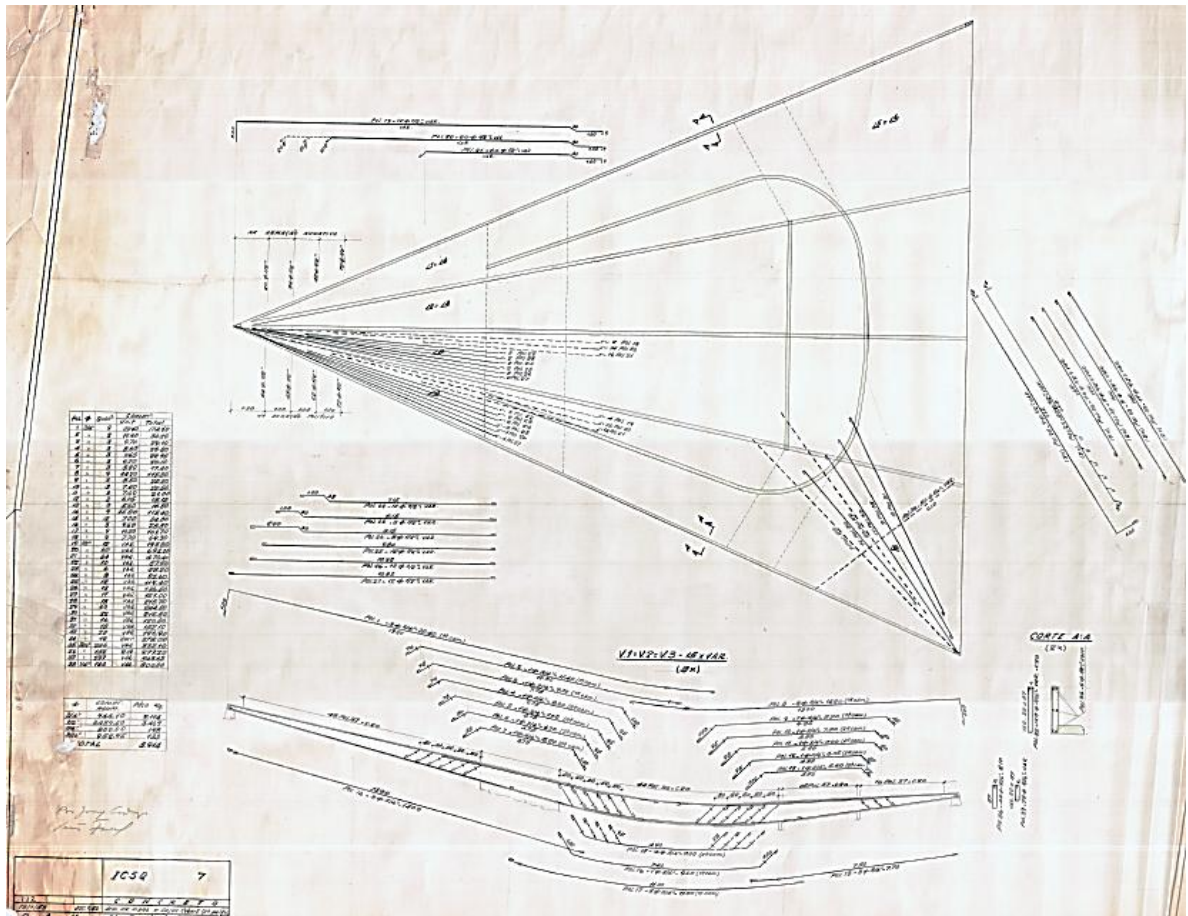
| Armação vigas e lajes - 2ª parte. 13.1 1958
